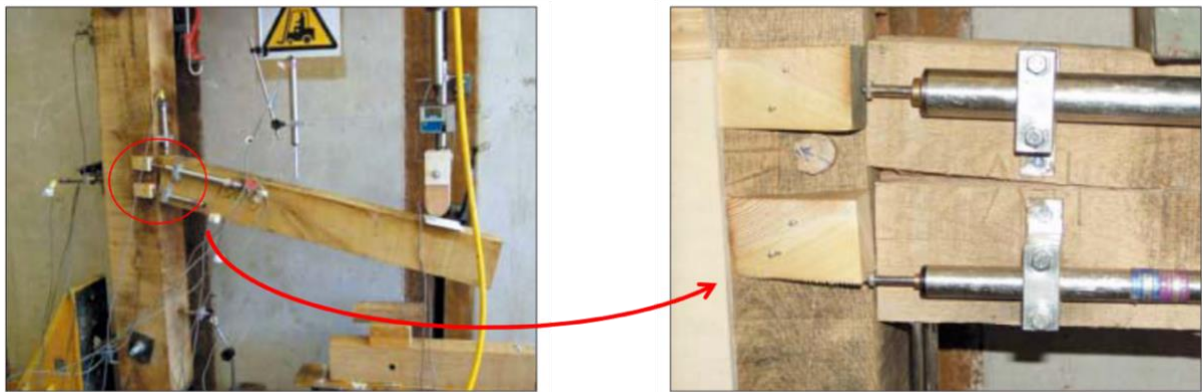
Dispositif d'essai de flexion sur des assemblages à tenon et mortaise avec chevilles en bois (Shanks and Walker, 2005)
